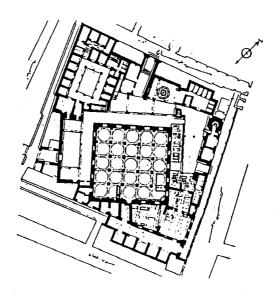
مسقط أفقي لمسجد المدجنين بطليطله . (عن : Moreno) .
